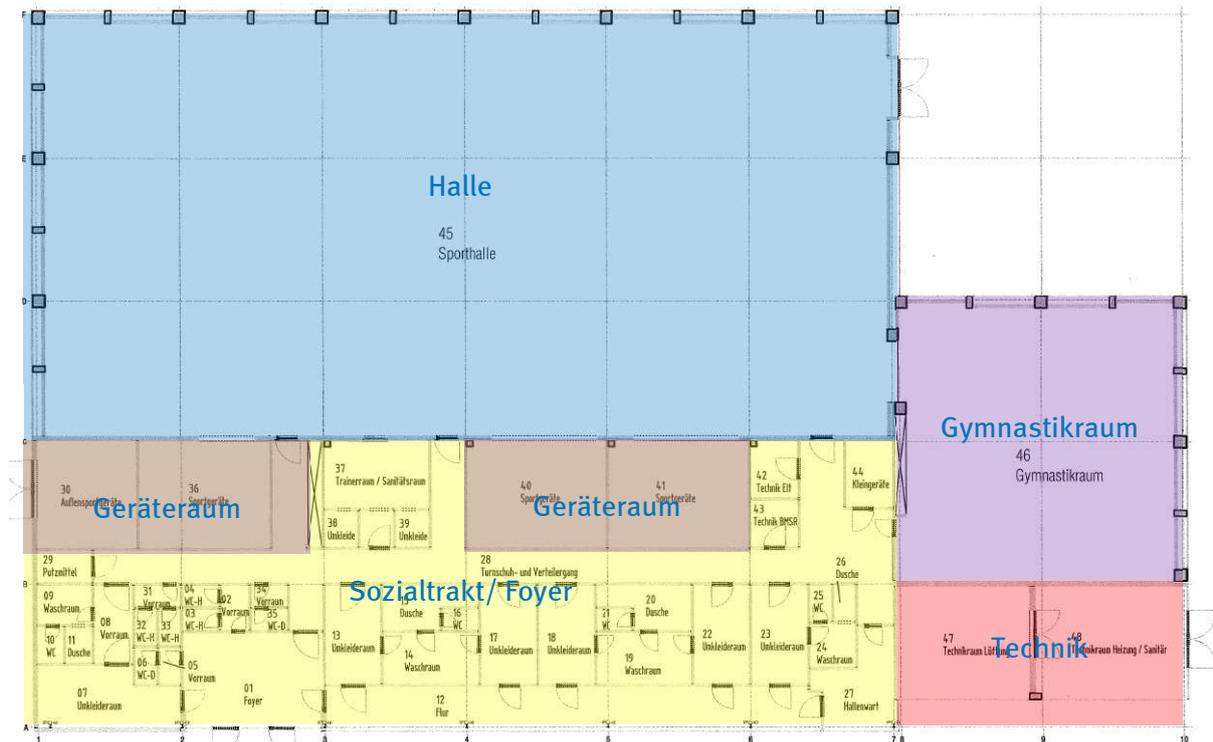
Grundriss TH 24 - Typ SH 18 x 36 (Quelle: ZGM)
